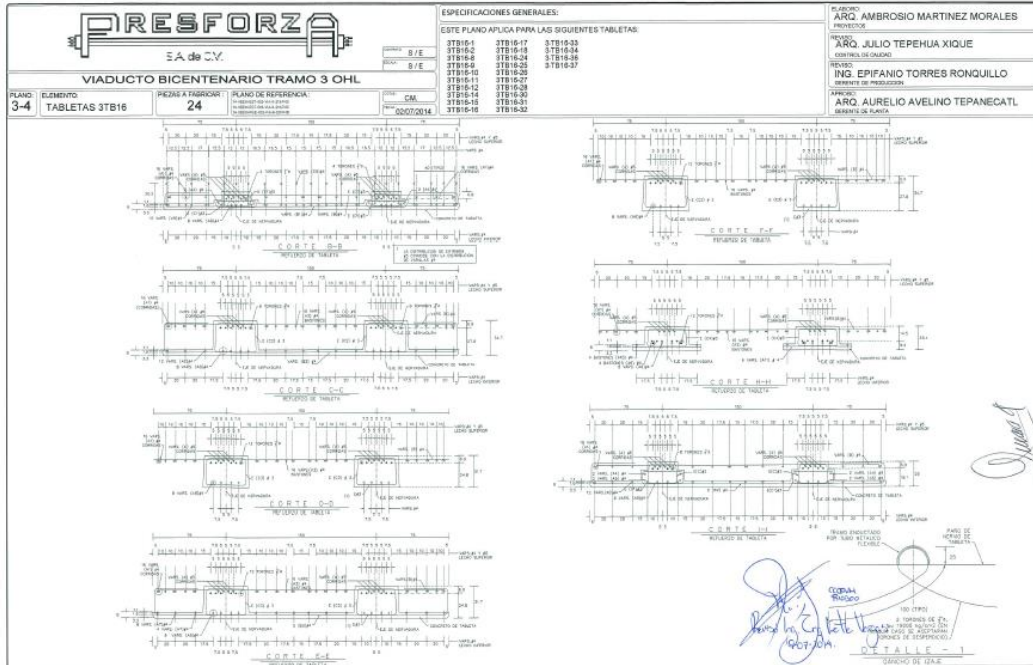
Plano estructural firmado para proceder a su fabricación.
